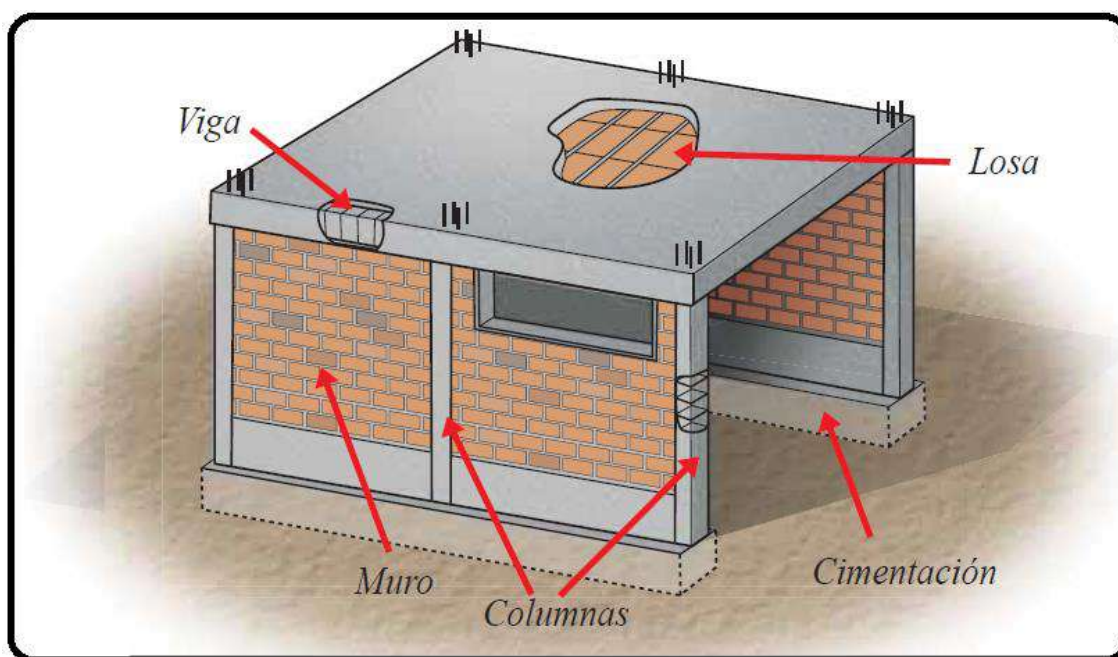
Elementos estructurales de una vivienda de albañilería confinada.
